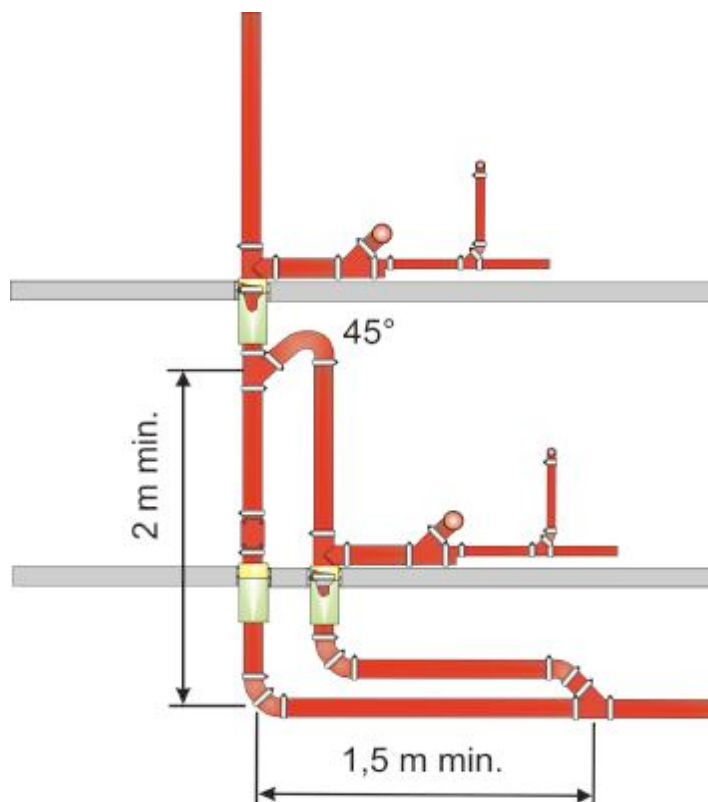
«Искривление вертикального трубопровода  $\geq 2$  м с обводным трубопроводом или обводной трубопровод для перехода напорного трубопровода в сборный или магистральный трубопровод (рис.11 из DIN 1986-100)
